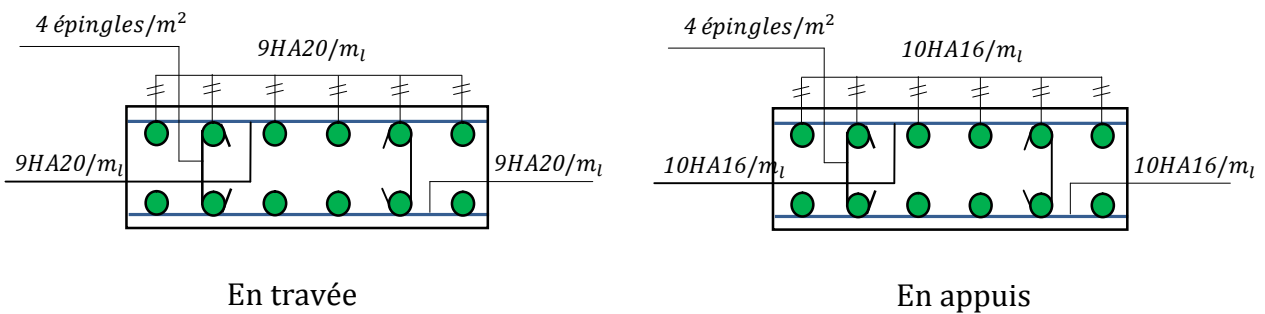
Schéma du ferrailage du mur adossé de 12.72m de hauteur.
